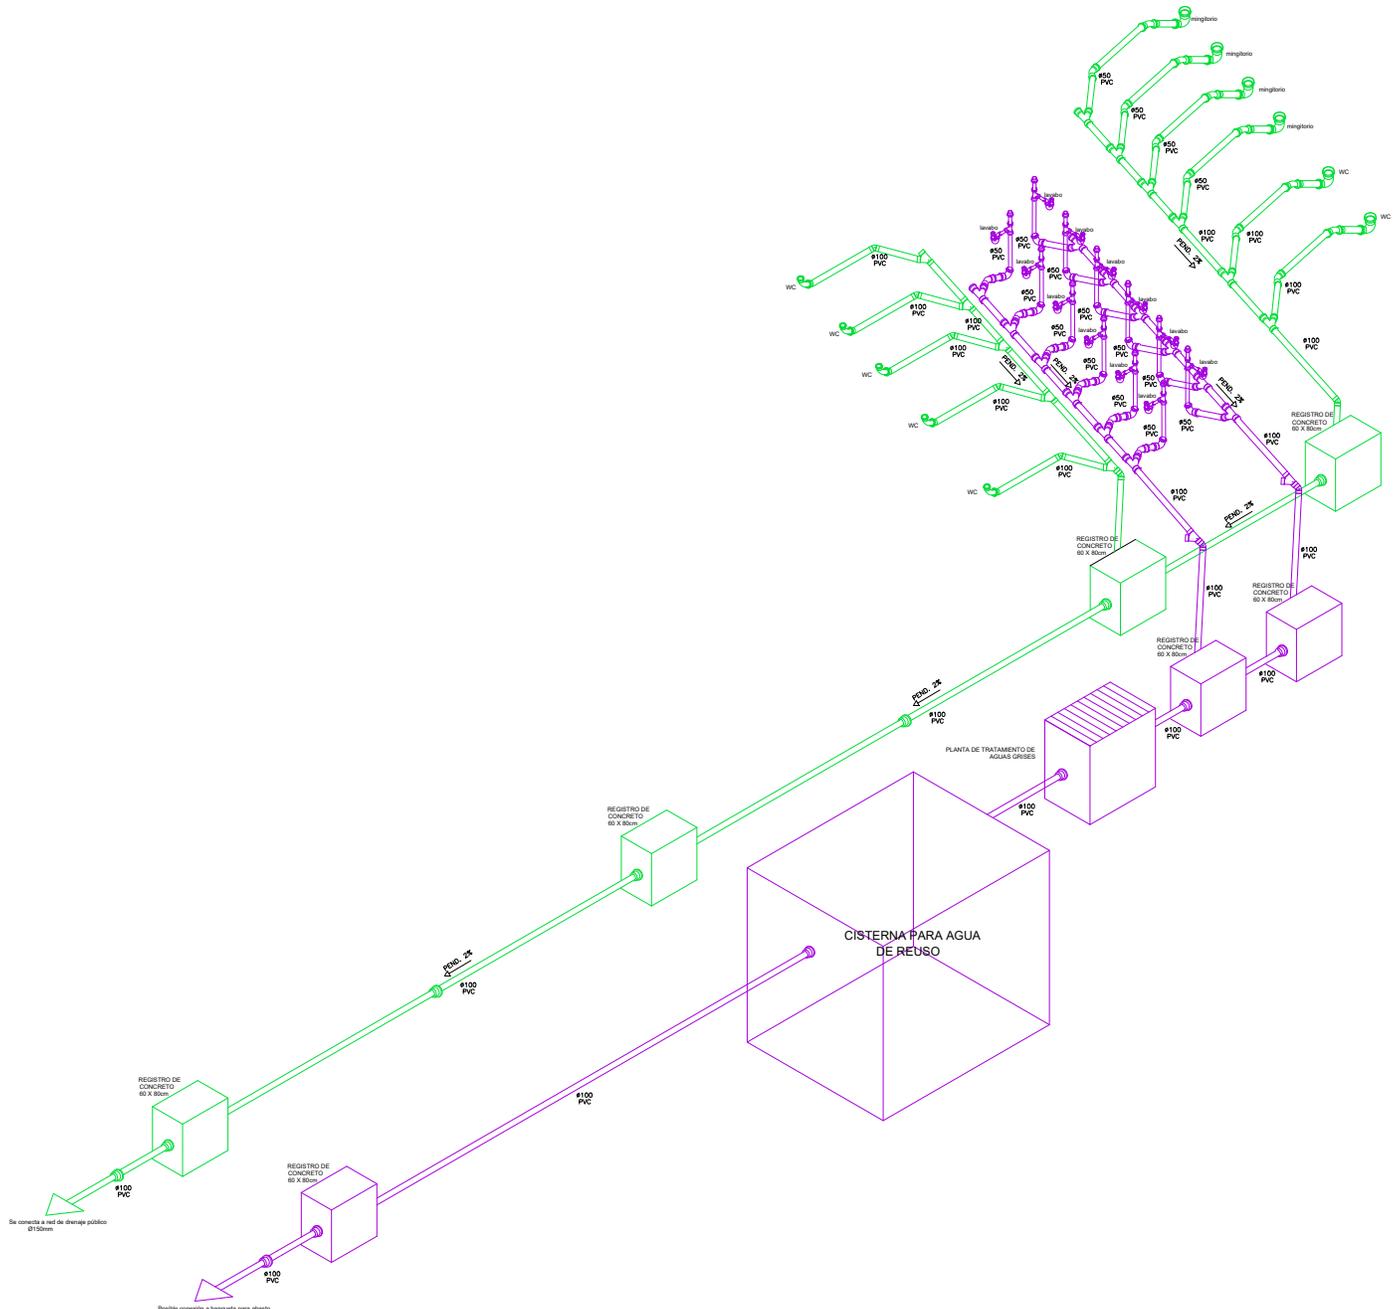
Isométrico instalación sanitaria planta baja conectado a la red de drenaje público de la calle de República de Uruguay
